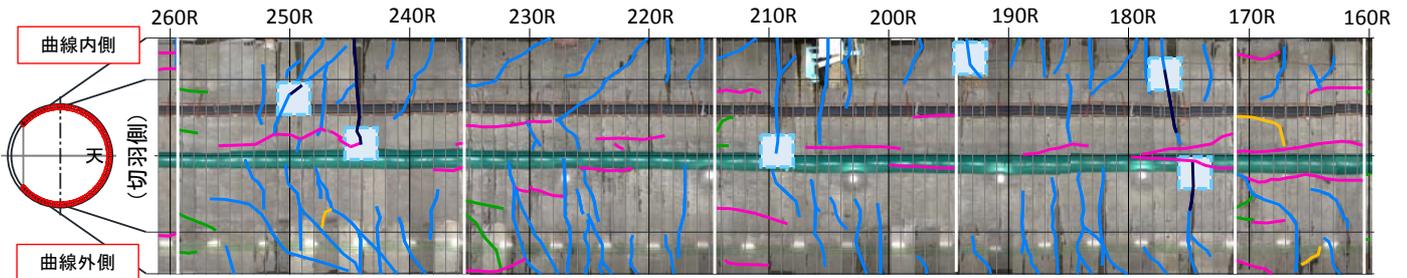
区間Bにおけるひび割れ展開図(一般区間 160R~260R)
